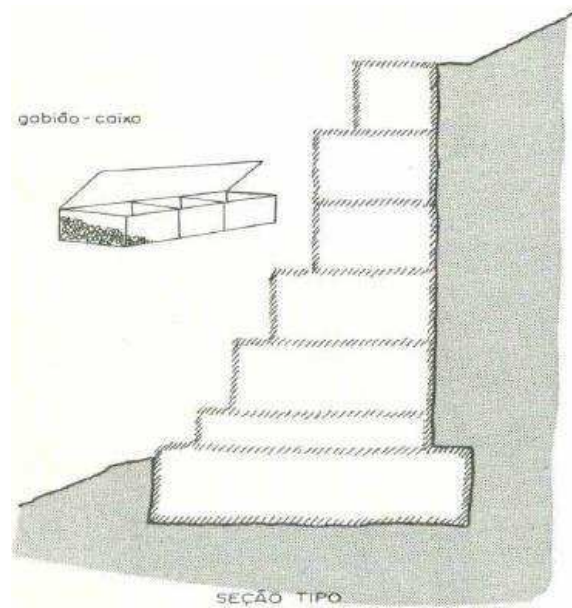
Muro de gabião-caixa. Fonte: CUNHA (1991).
